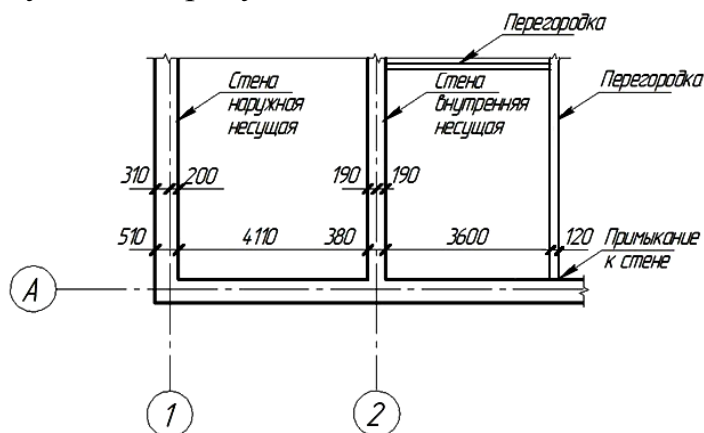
Пример обозначения на планах несущих стен здания
